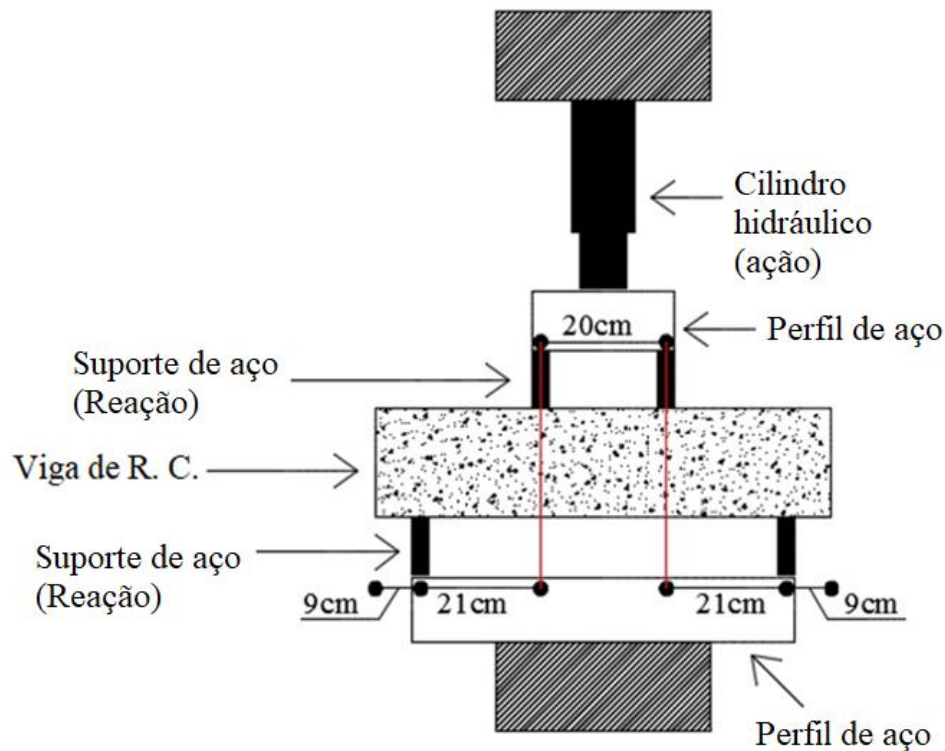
Detalhes da prensa utilizada com viga em ensaio de Stuttgart.
